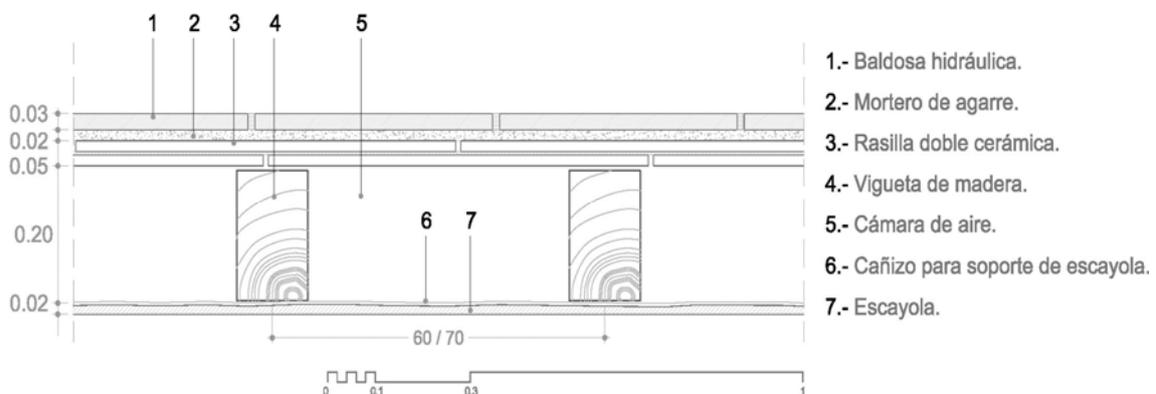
Detalle constructivo del forjado existente. Orenes García, Matías J., 2015.
